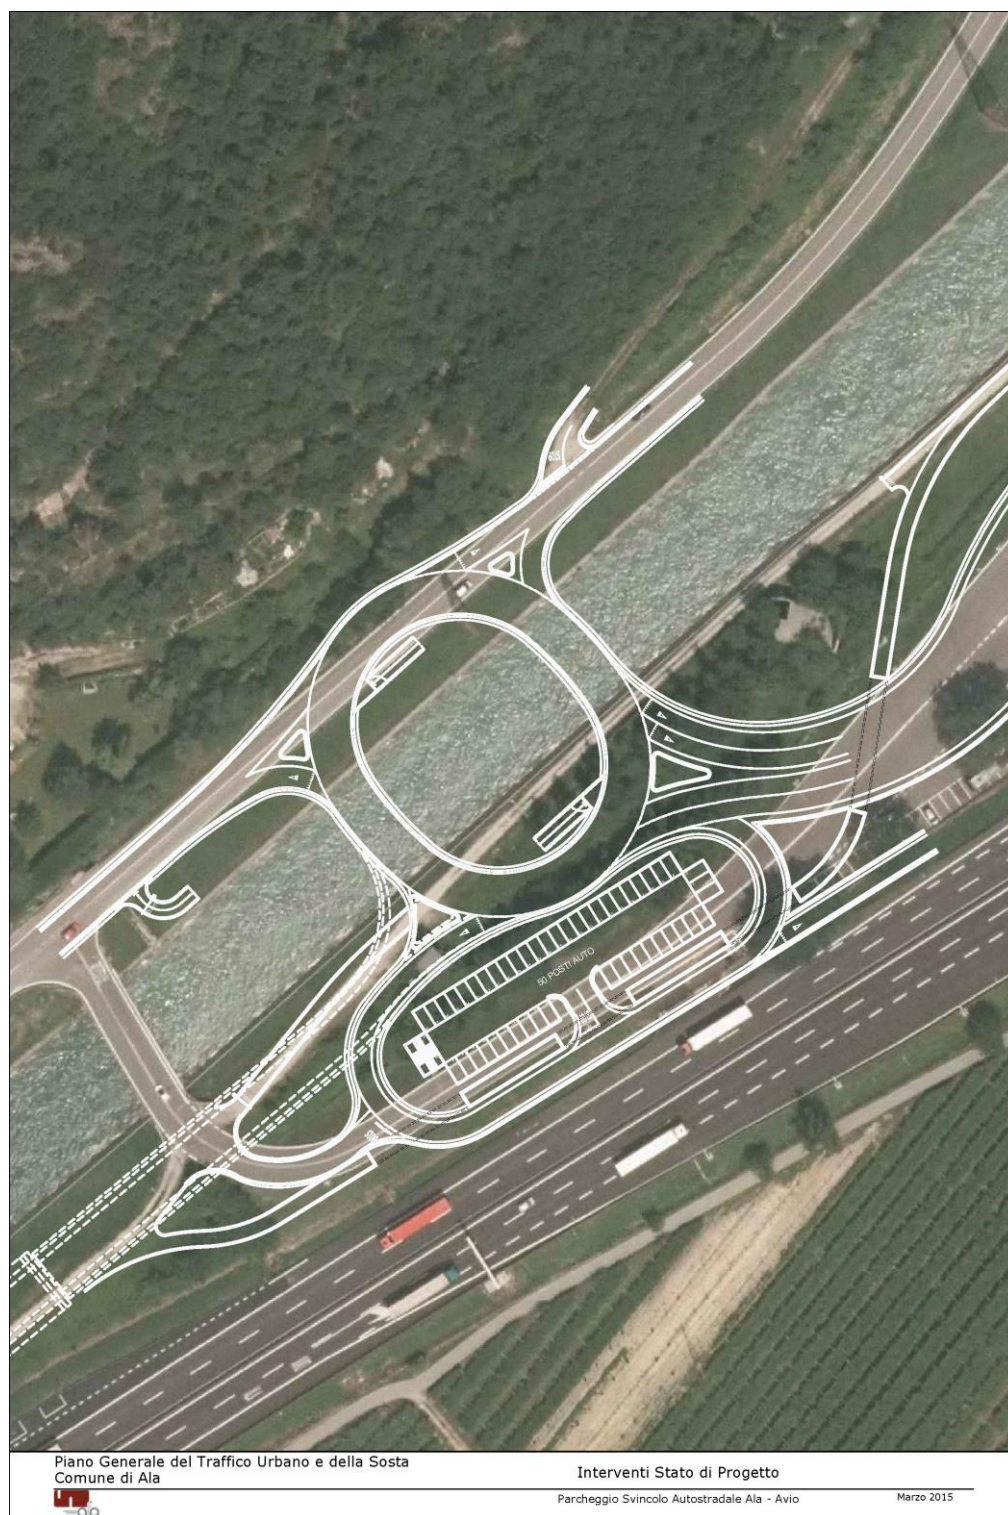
Interventi Stato di Progetto – Breve Termine – Parcheggio Svincolo autostradale Ala – Avio
